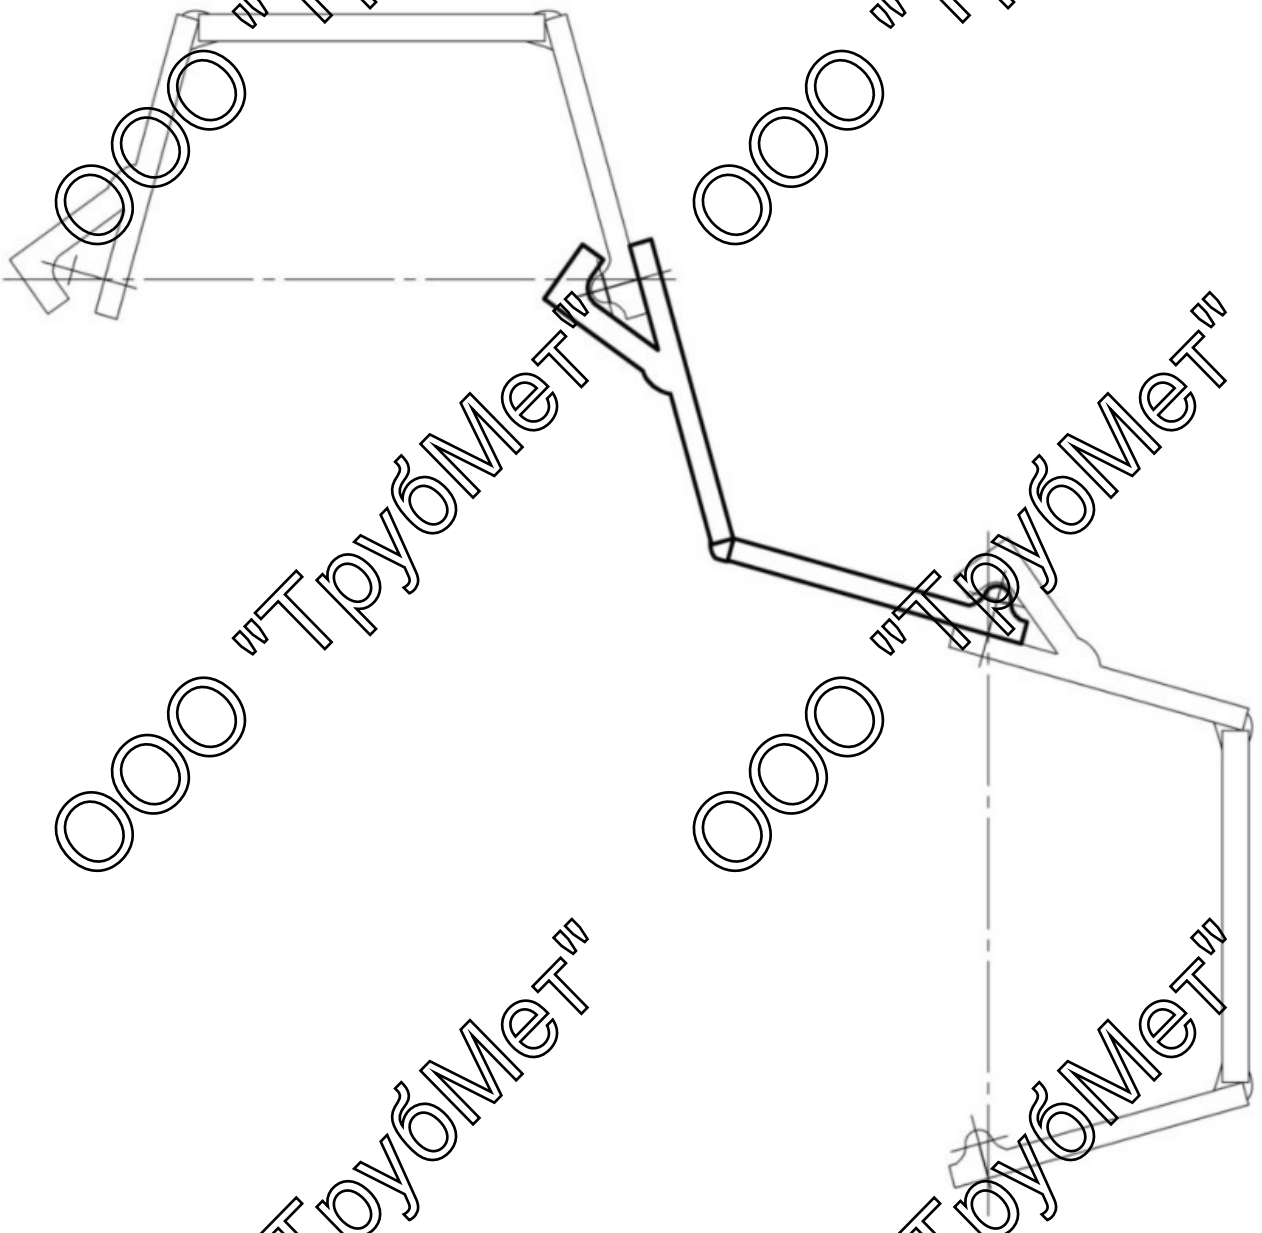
Схема поворота шпунтовой стены на заданный угол путём использования угловых профилей СШК.
